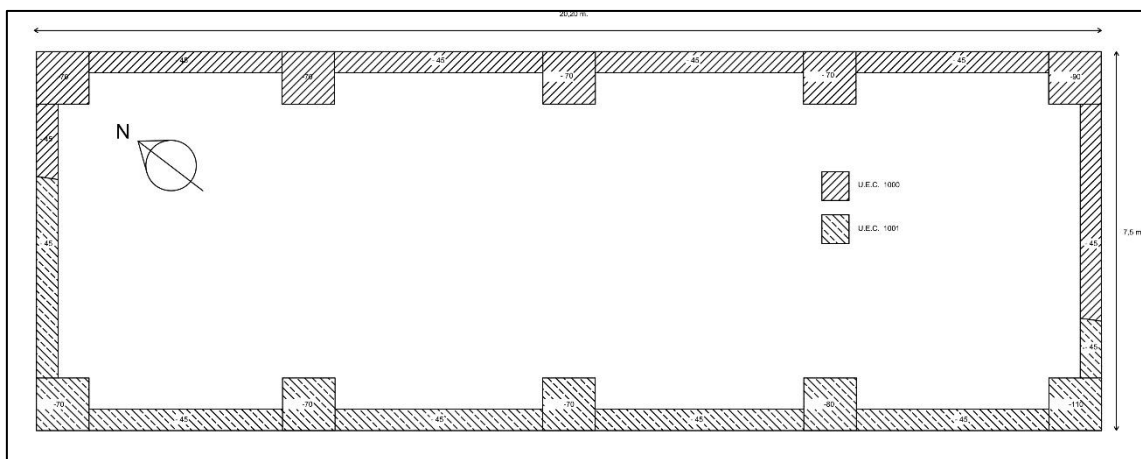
Planta de la cimentación con las cotas alcanzadas bajo la superficie del terreno y las unidades estratigráficas identificadas.
